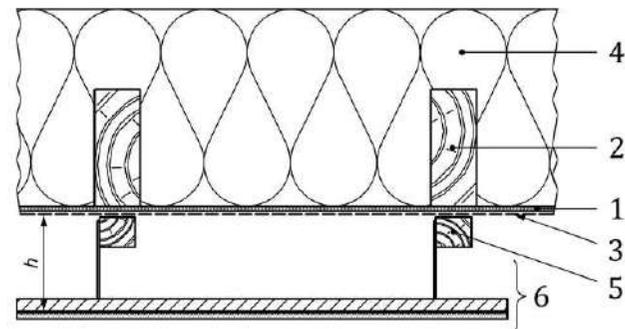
Membrane en sous-face du support avec création d'un plenum en plafond suspendu
